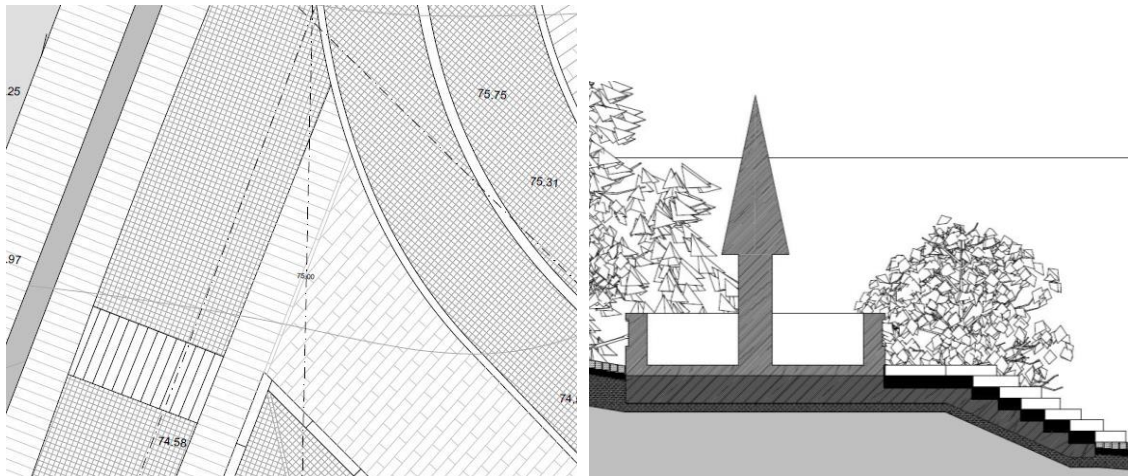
Pormenor desenho de pavimentos dos passeios, faixa rodoviária e passadeiras; Corte construtivo fonte do Largo Ator Dias. Fonte: Autor (sem escala).
